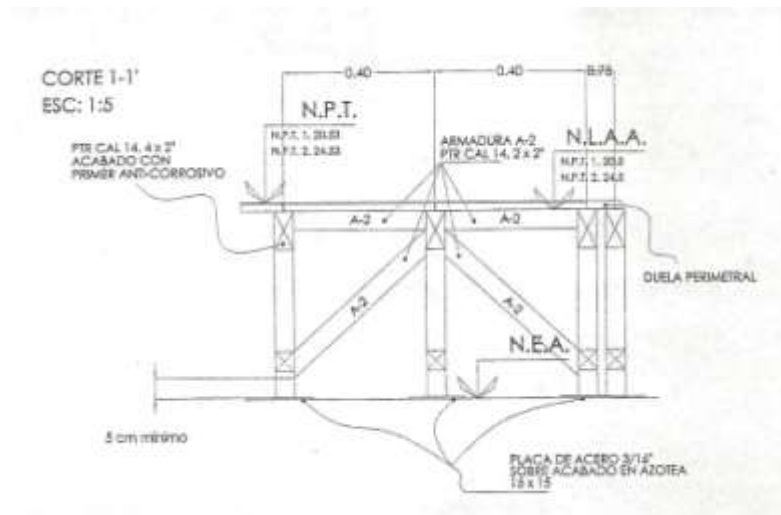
Vista Perfil de la Estructuración del piso Deck
